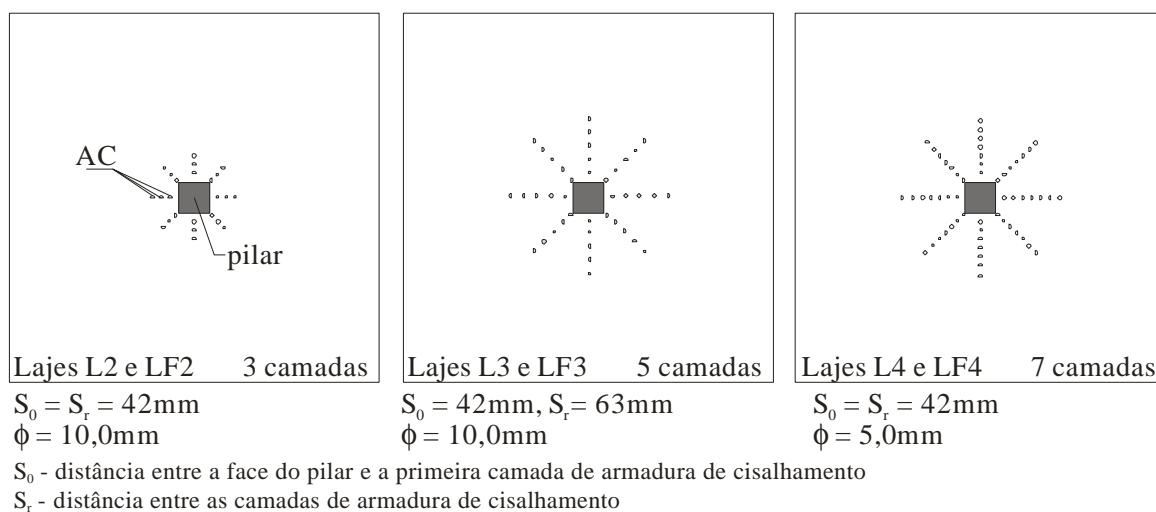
Distribuição da armadura de cisalhamento das lajes de Musse (2004)
